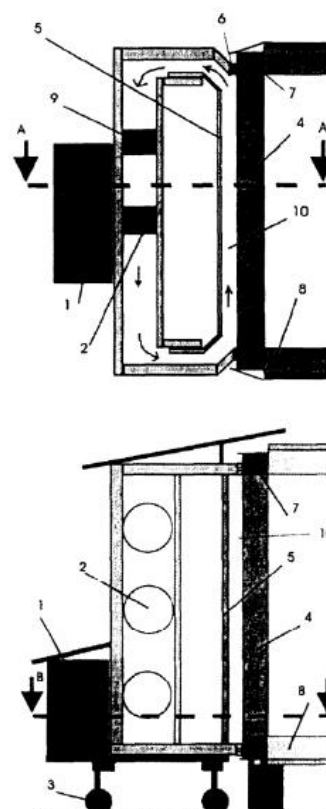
Schema di installazione della Cold Box (sezione orizzontale e verticale).
